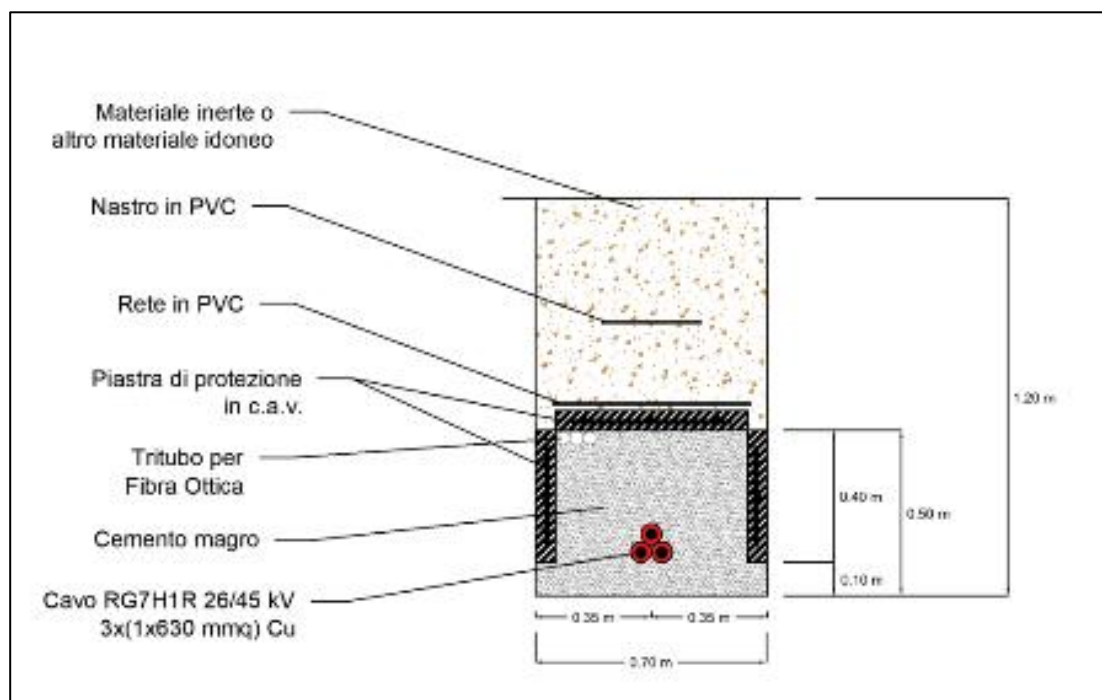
Tipico della sezione di scavo dell'ultimo tratto di cavidotto di connessione a 36 kV
